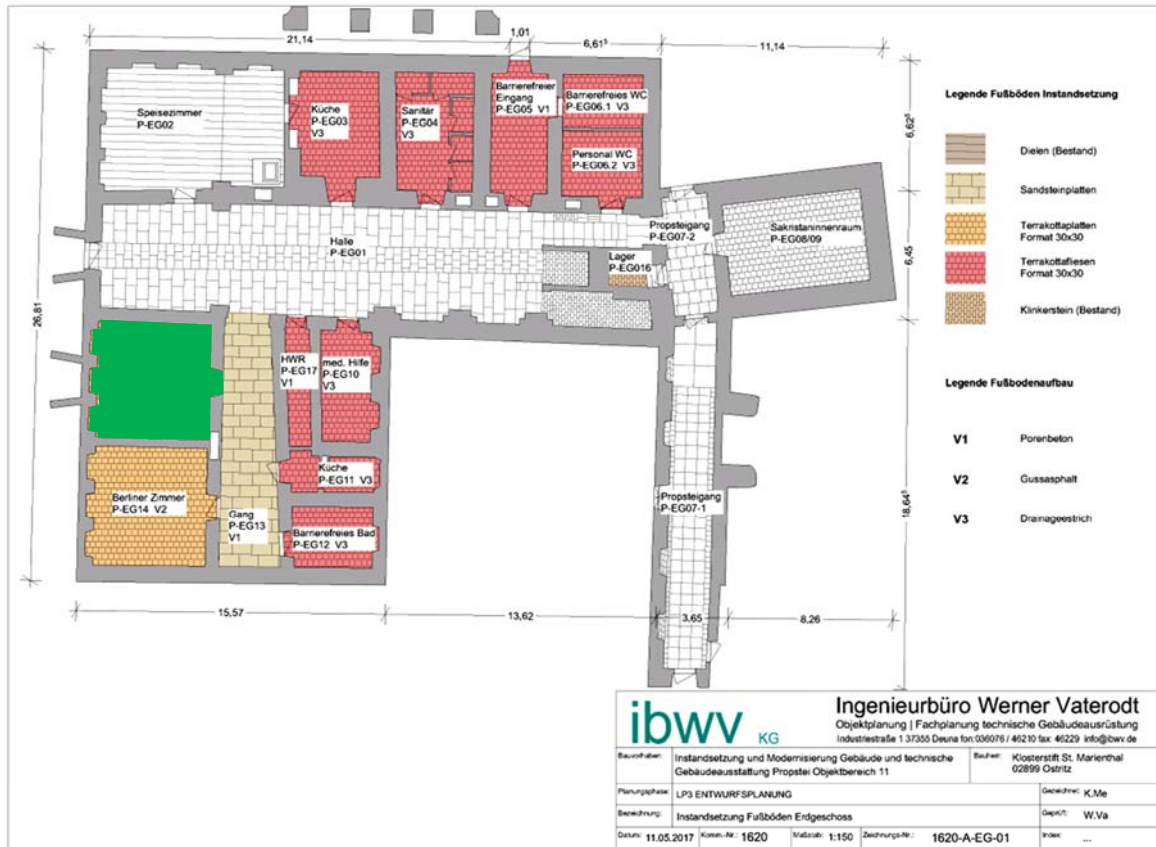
Grundriss Propstei mit Markierung des Raumes P-EG 15 / Gussasphalt-Estrich
